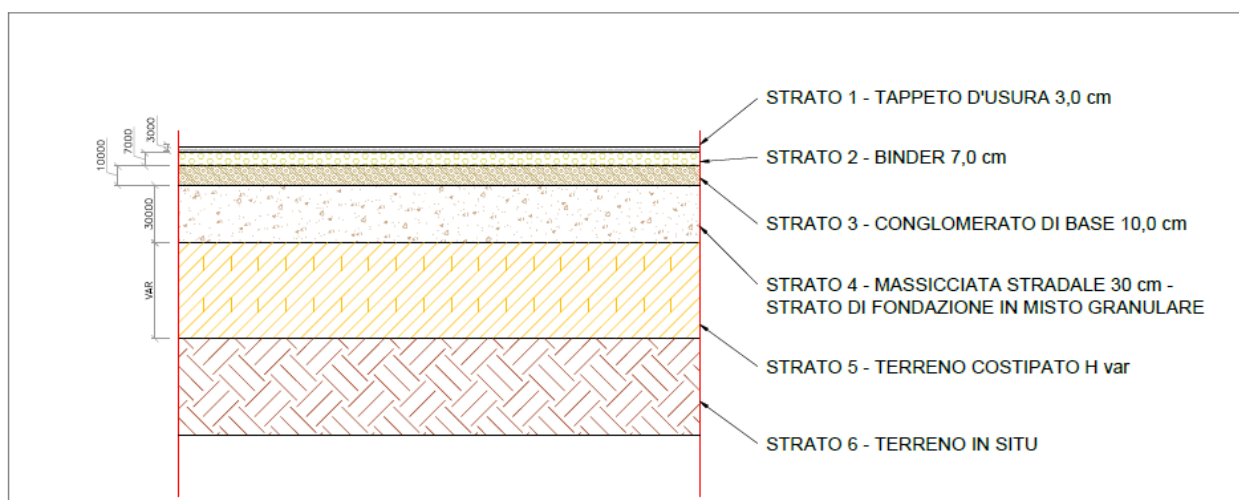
Stralcio tavola ESE.EGR.EST.001 - Planimetria e particolari pavimentazioni esterne
